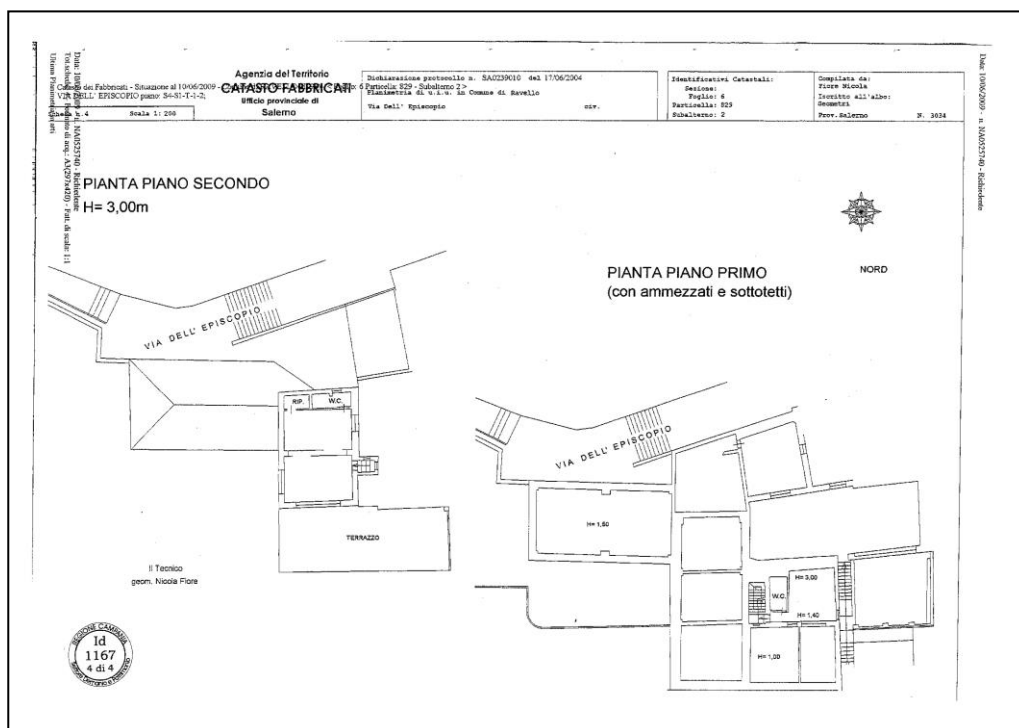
NCEU Comune di Ravello – Planimetria catastale Villa Episcopo (piante q. +2.80 e +5.85) particella 829 sub 2, Pianta primo e secondo con ammezzato e sottotetto
